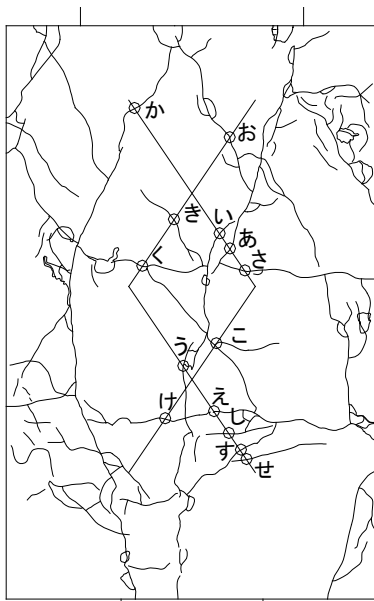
パイルキャップひび割れ幅測定位置 (試験体 A-4 正載荷)
